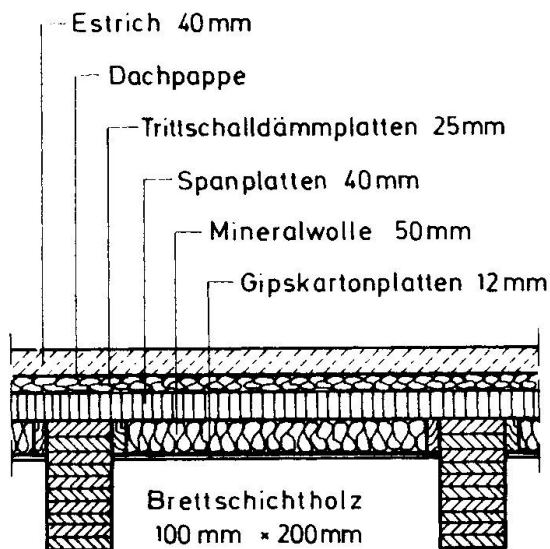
Querschnitt einer Holzbalkendecke (nach [1])
